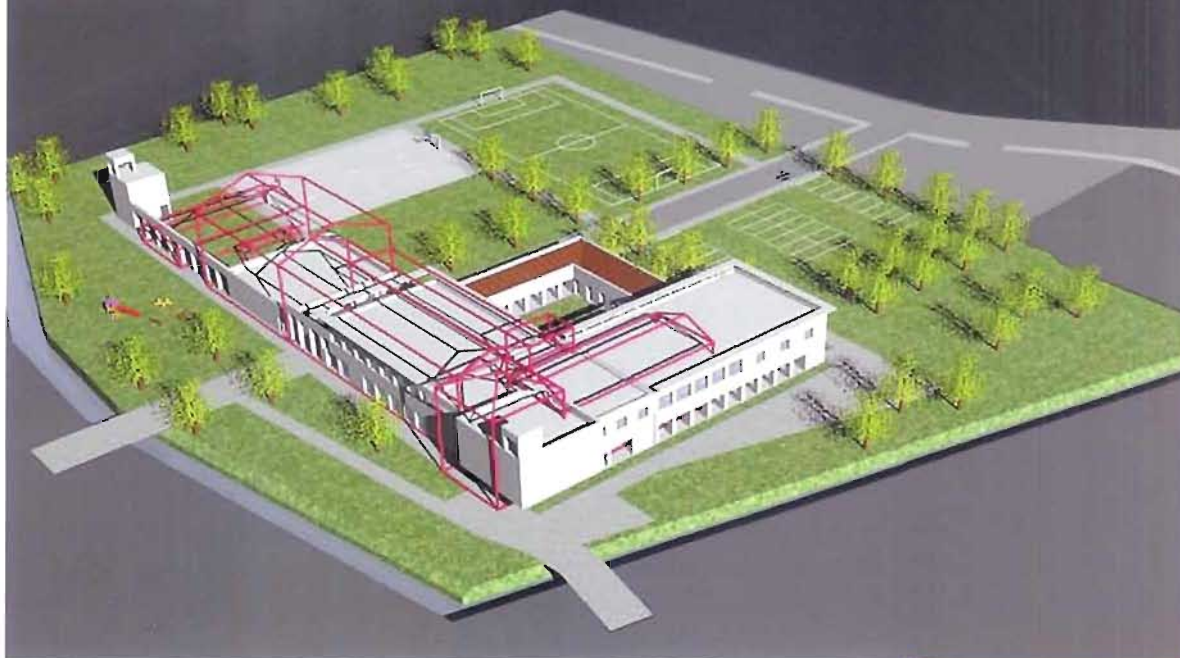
volumetrie dell'attuale Oratorio (indicate dalle linee rosse), sovrapposte al progetto della nuova costruzione
